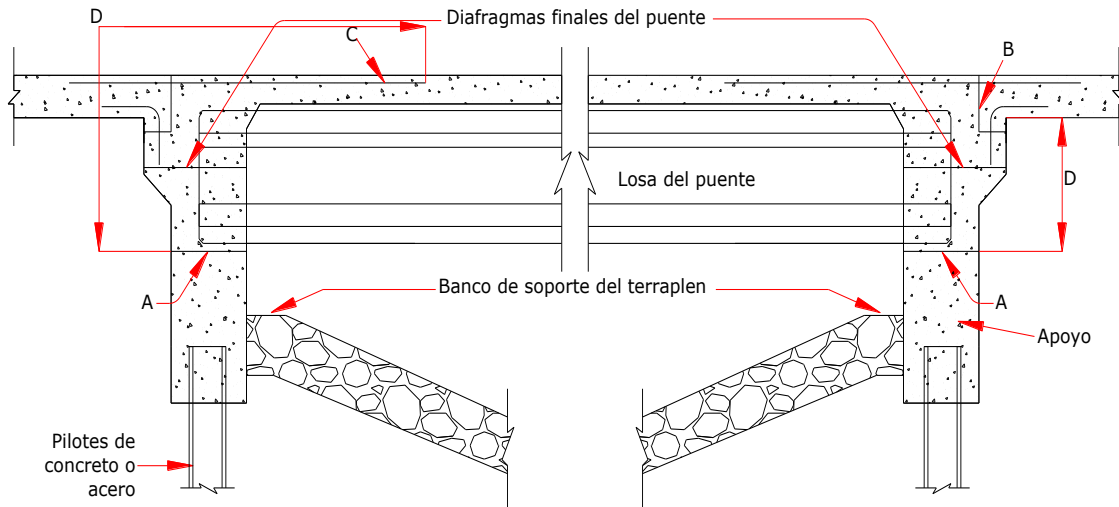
Construcción de juntas (A, B y C) y continuidad de la conexión en el estribo con la superestructura, (D) para dos diferentes estribos de puentes integrales.
